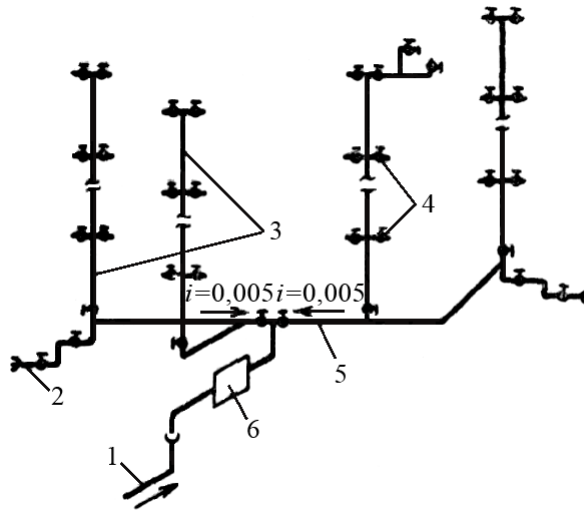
Система водоснабжения здания, действующая под напором в наружном водопроводе: 1 – ввод; 2 – поливочный кран; 3 – распределительные трубопроводы (стояки); 4 – вентили на поэтажной подводке; 5 – магистральный трубопровод; 6 – водомерный узел
